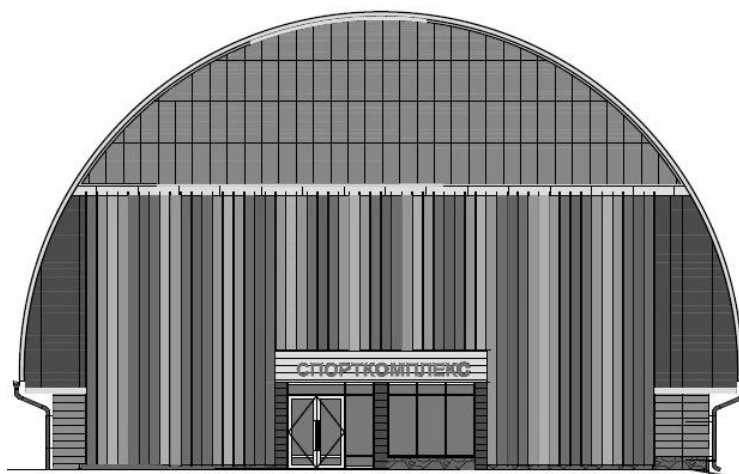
Фасад проектируемого здания спортивного комплекса
